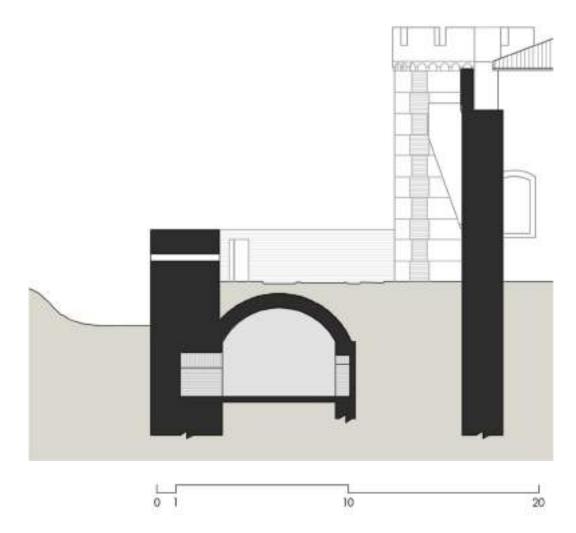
Barrera artillera y galerías subterráneas de Castronuevo_ Sección longitudinal_ Estado actual. Elaboración propia.
